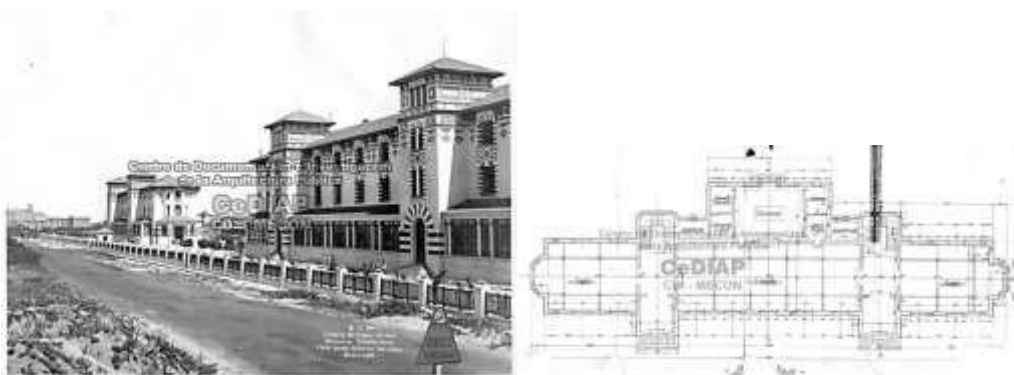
Vista y planta baja de la Colonia Raimondi, primeros pabellones. Archivo Cediap
